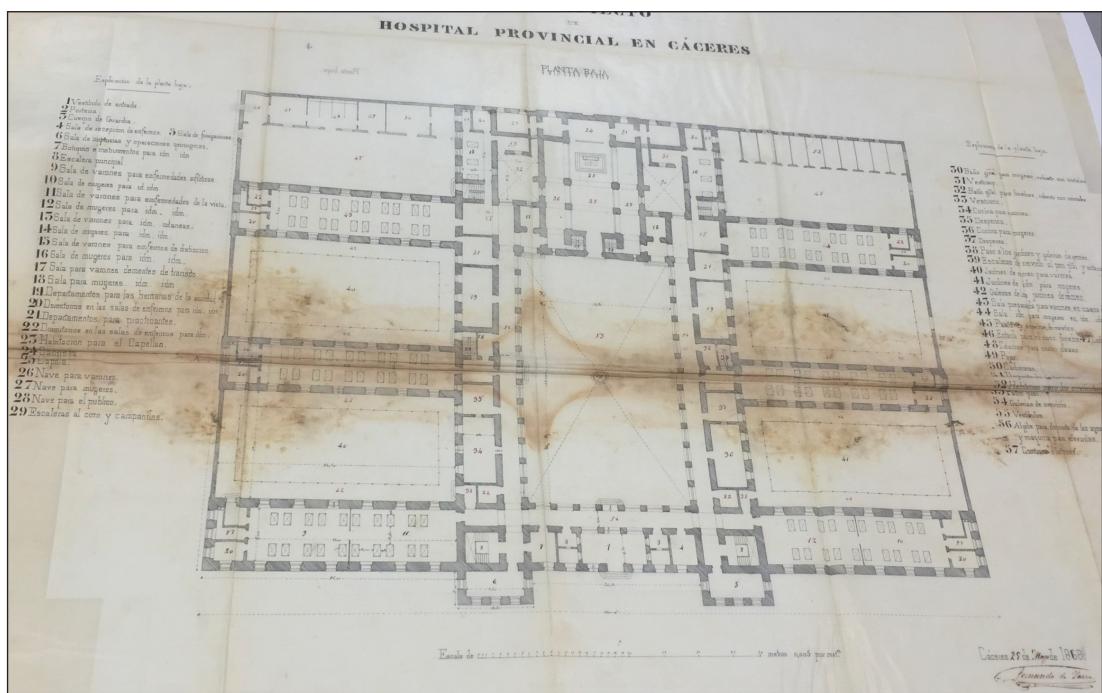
Proyecto de Fernando de Yarza, 1868, planta baja. ES.10037. ADPCC/FDP01.03.05.02.02/3539
